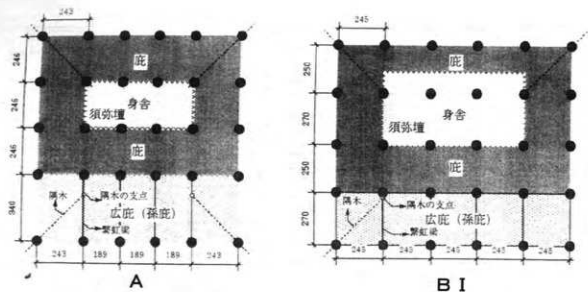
大知波岬廃寺建物A(左)及び建物B I 平面図(1/200)
